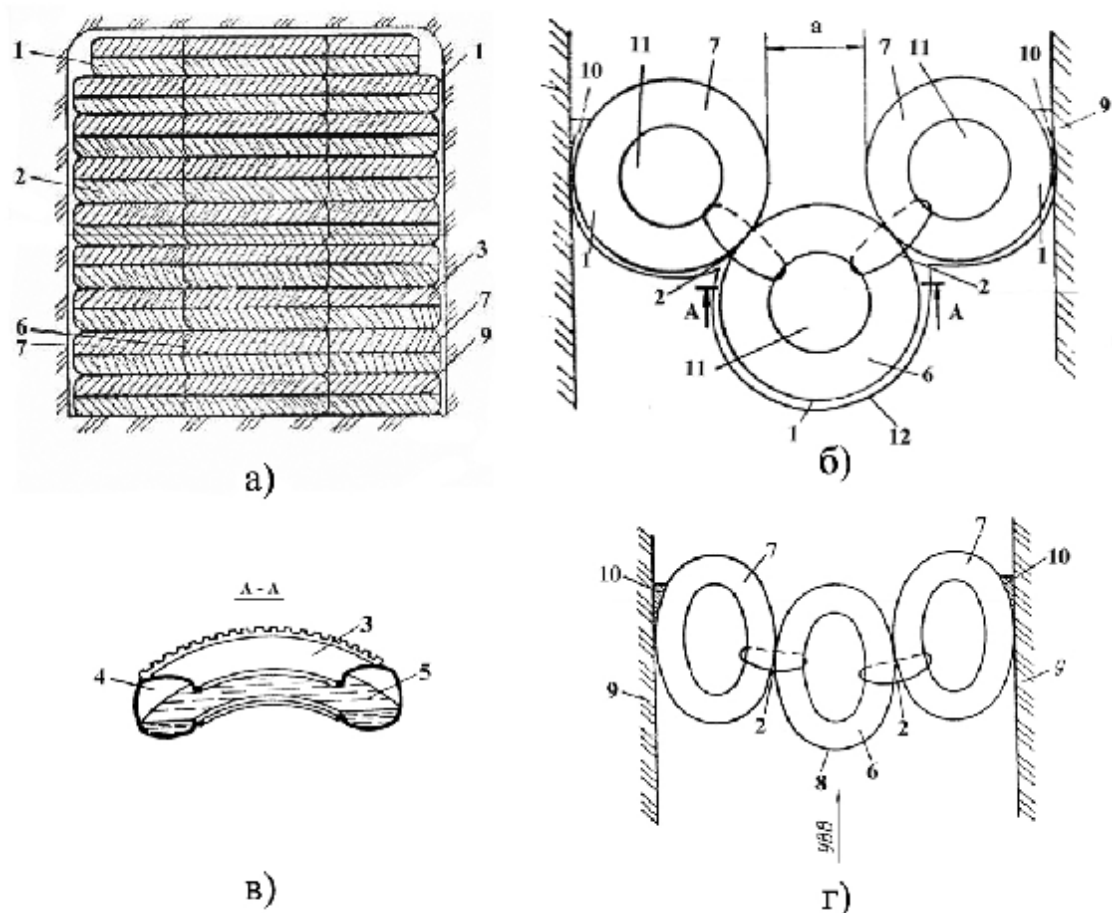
Конструкция вентиляционной перемычки, устойчивой к ударной волне:
